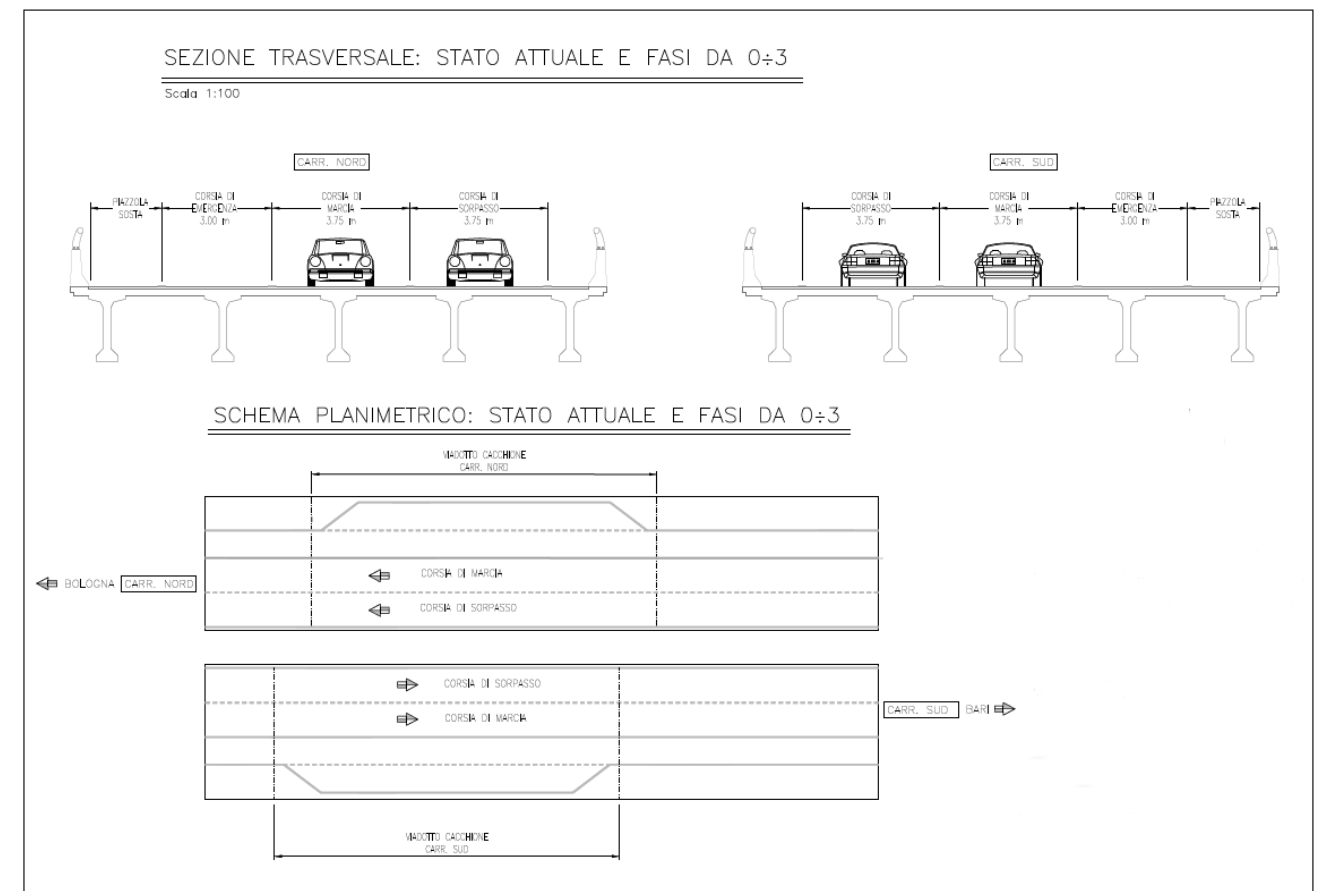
Sezione trasversale: Stato attuale e fasi da 0 ÷ 3
